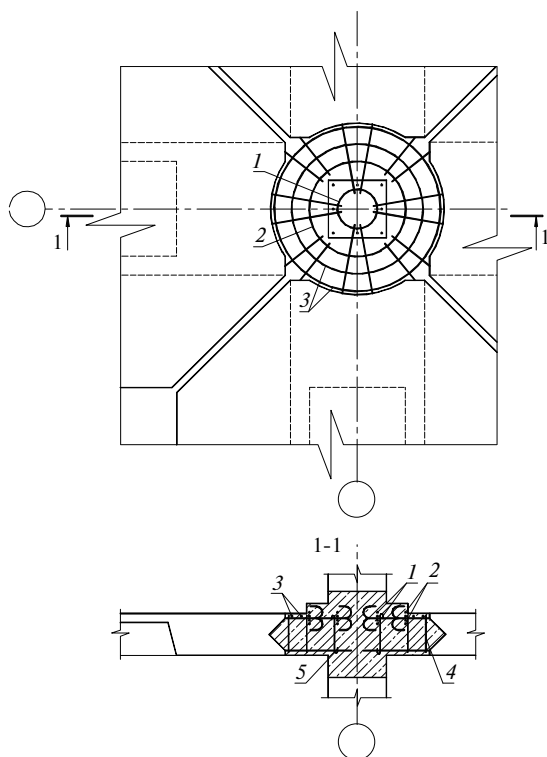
Квадратная ячейка перекрытия с контурными ригелями.
